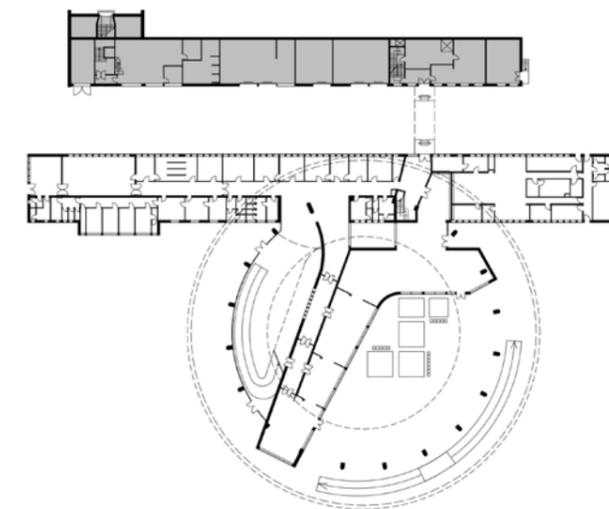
Wohn- und Nebengebäude im Grundriss
